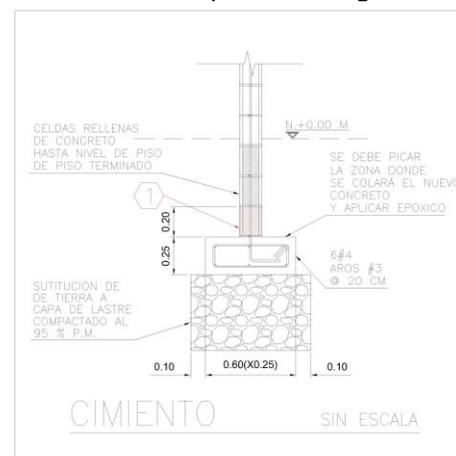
Zona de Perforación en mampostería. Autocad 2005.
